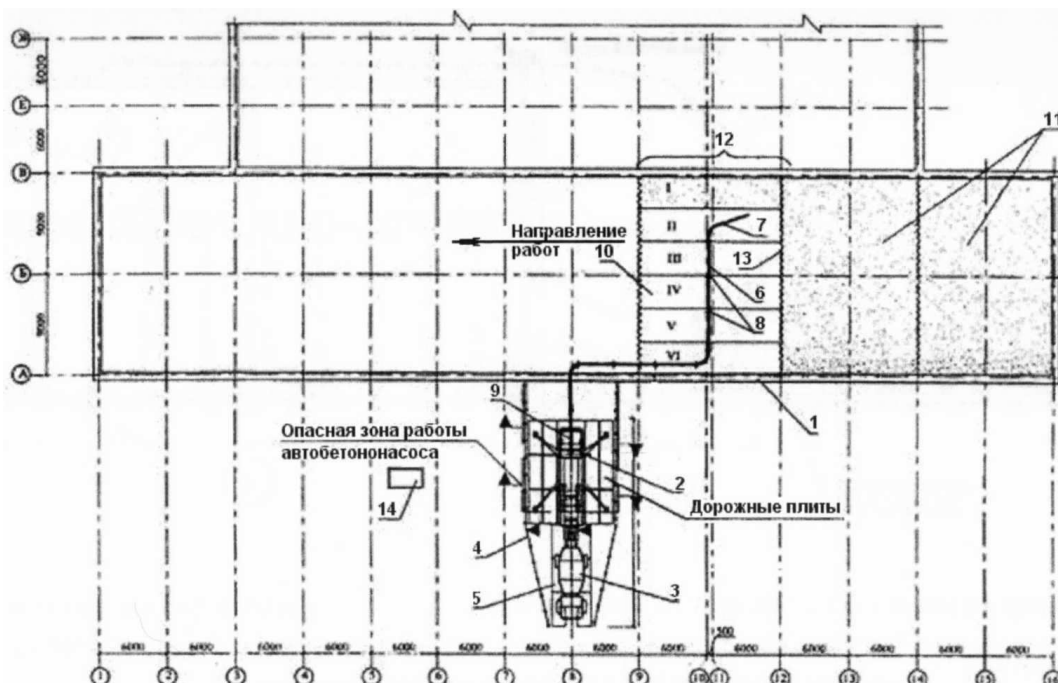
Схема организации рабочего места при выполнении работ по бетонированию перекрытия
